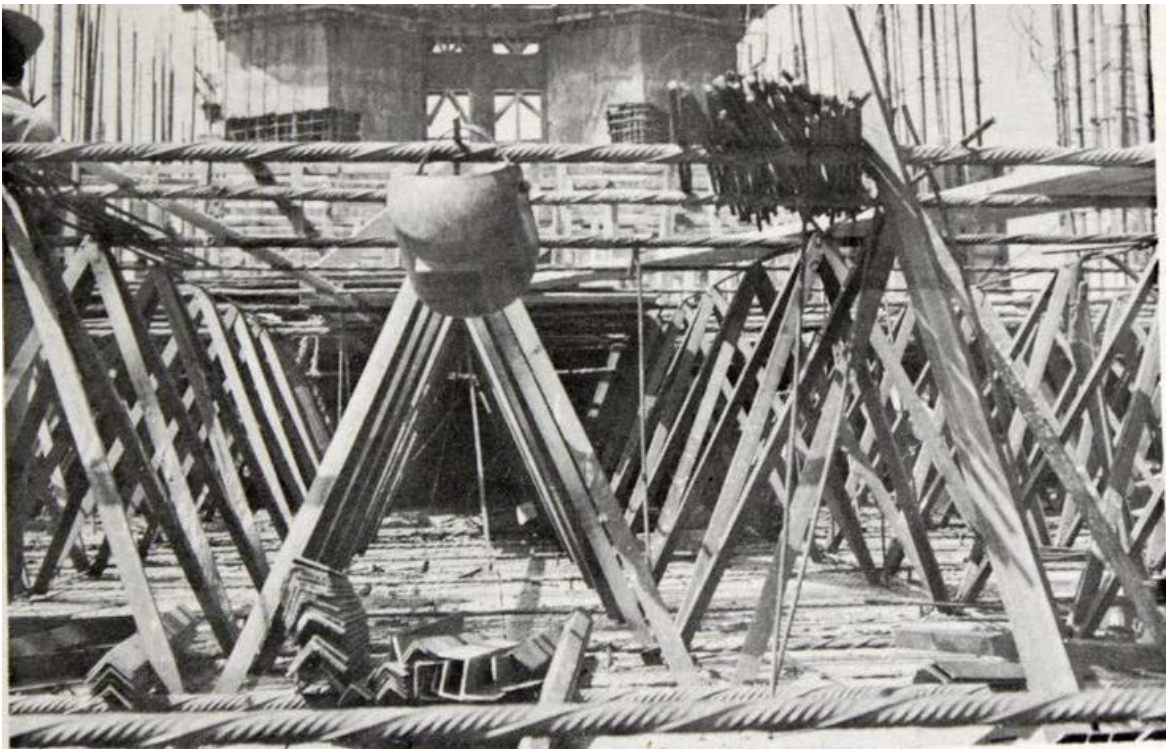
Díaz Infante. Bufete Industrial. Destaca la cubierta sostenida por la armadura espacial tridimensional, compuesta geoméricamente por módulos de rombos desfasados.
